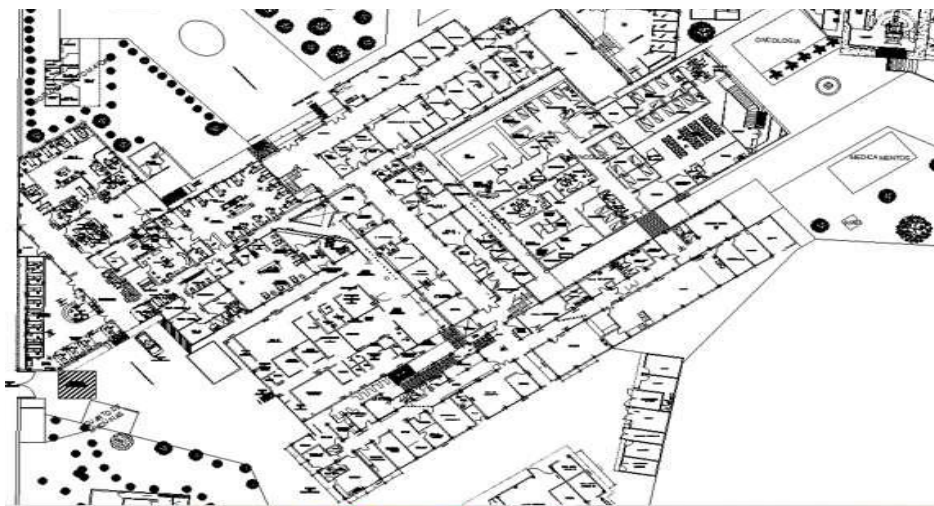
Planta de Conjunto. Fuente. Secretaria de Salud. 2020.
